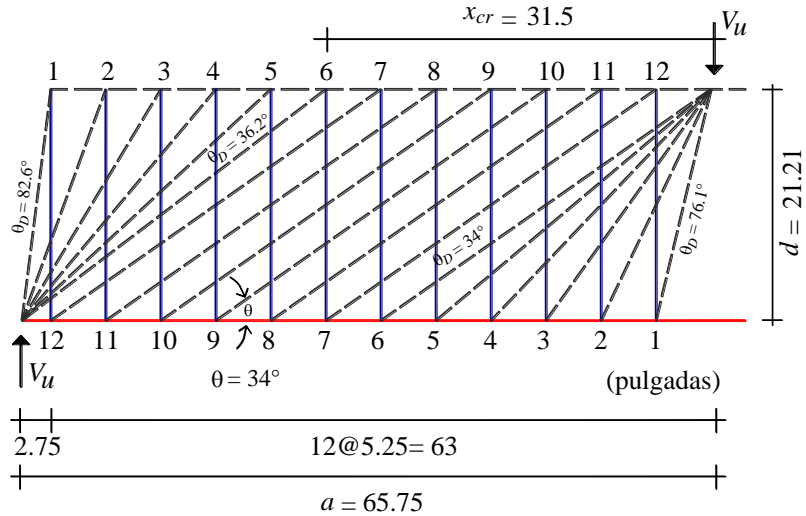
Patrón de agrietamiento de la viga 1 ensayada por Johnson y Ramírez (1988)
